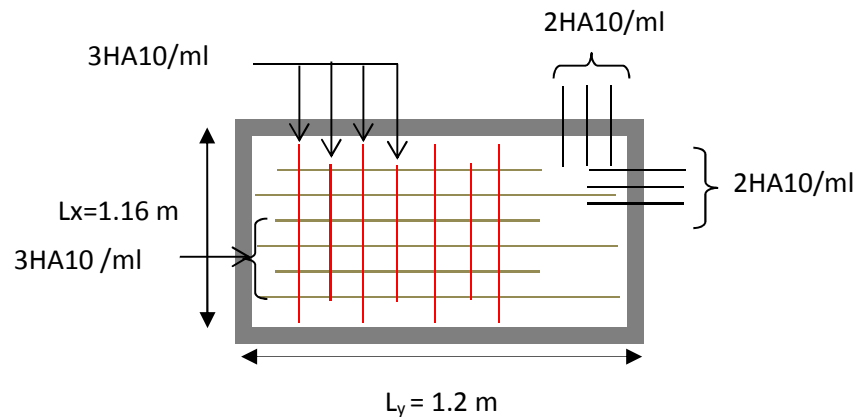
Schéma de ferrailage de la dalle d'ascenseur
